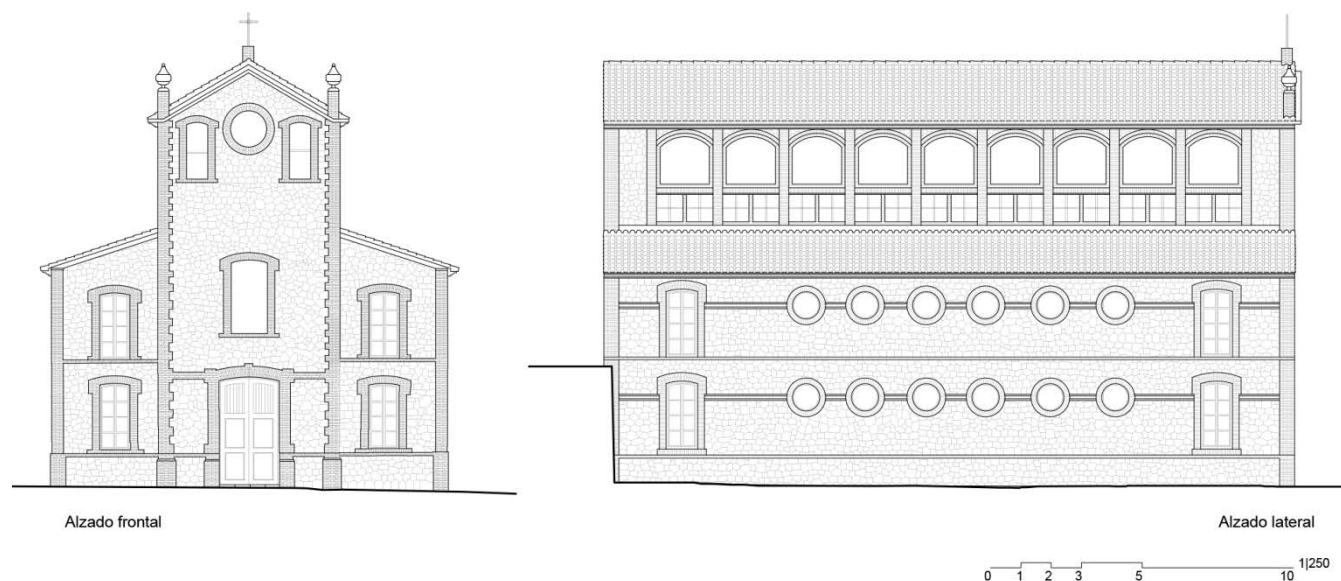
Levantamiento Planimétrico de Pabellón de Baños. Salón de Actos. Teatro. Fase 2 (1922-1958).
